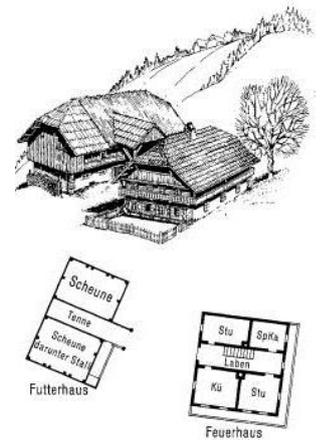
Paarhof samt Grundriss (austria-forum.org 2016, online)
